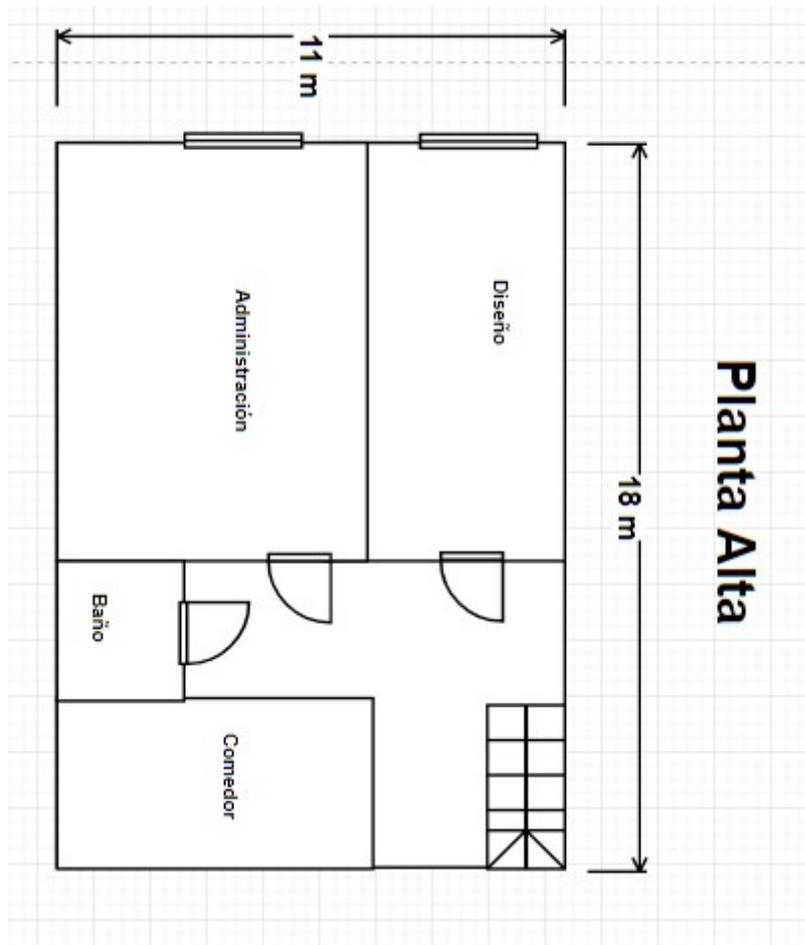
Lay Out de la planta alta de la nueva fábrica.
